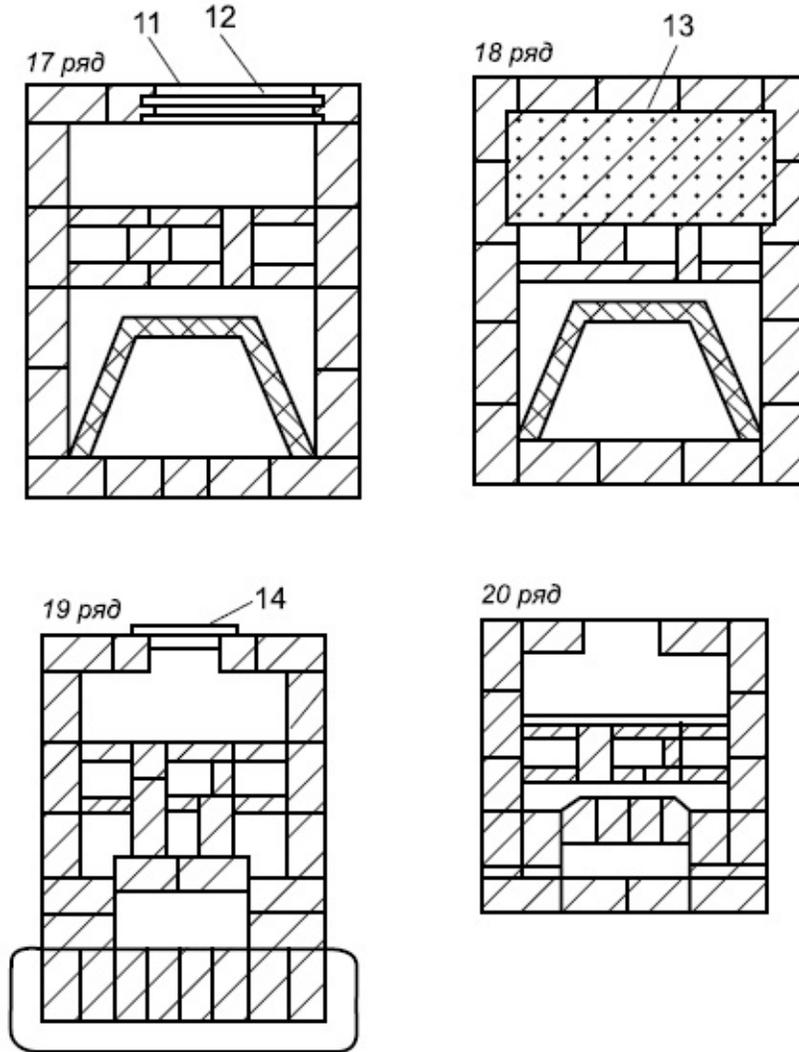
Кладка отопительно-варочной печи с камином (продолжение): 11 – уголок; 12 – стальная полоска; 13 – оцинкованный
